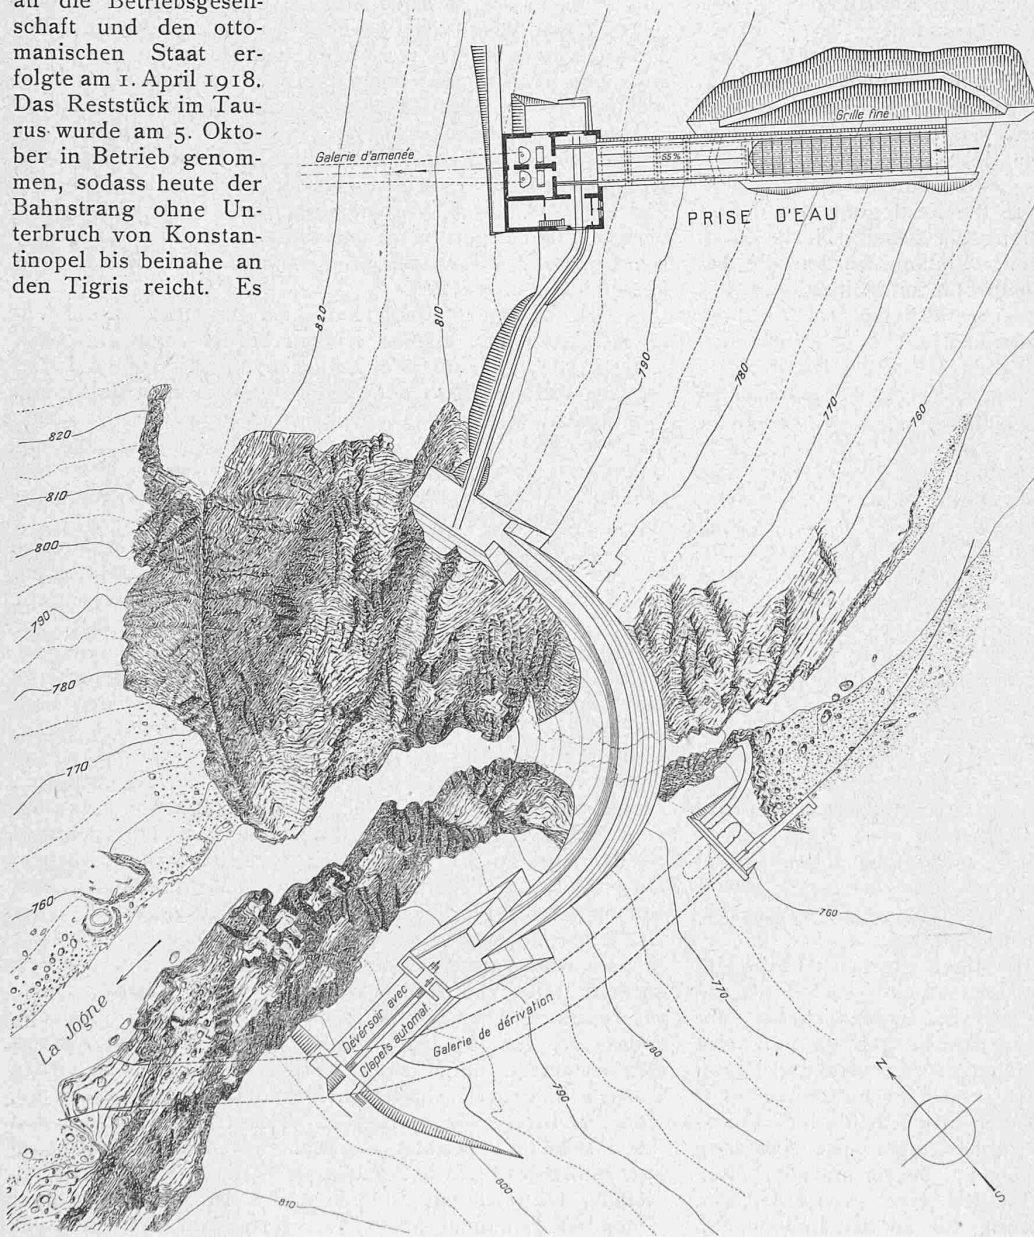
Lageplan des Staudammes und der Wasserfassung zum Kraftwerk Broc. — Masstab 1 : 1000.
